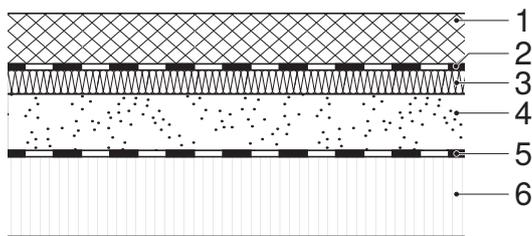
Aufbau einer Brettstapeldecke, beschwert mit einer Betonschicht
